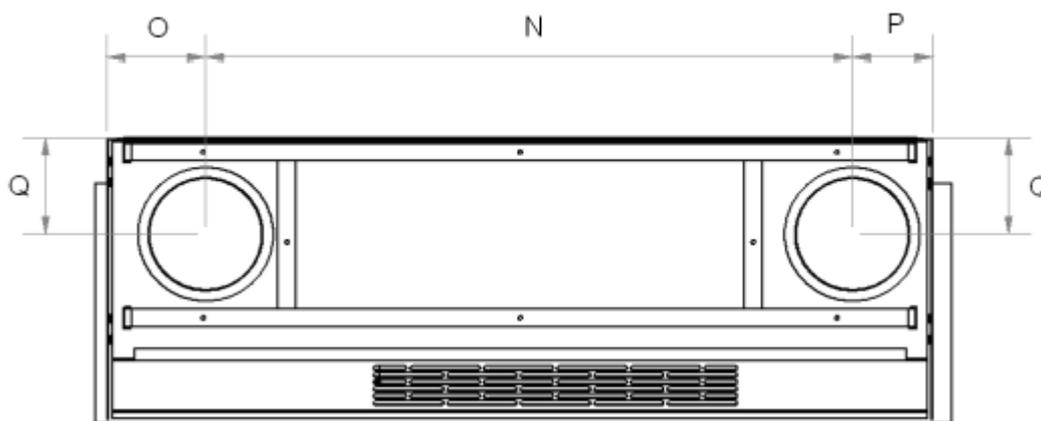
Deckenmontiert mit Deckendurchführungen
